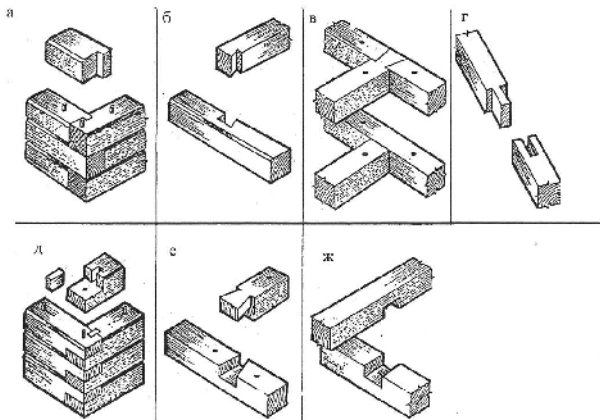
Соединения брусчатых стен: а - угловое соединение брусьев в перевязку с коренным шипом; б - сопряжение внутренней стенки с наружной полусковороднем; в - сопряжение внутренней стены с наружной в перевязку; г - сращивание брусьев; д - угловое сопряжение брусьев в поддерева на нагелях и оставных шпонках; е - сопряжение внутренней стены с наружной сквороднем; ж - сопряжение брусьев в перекрестии
